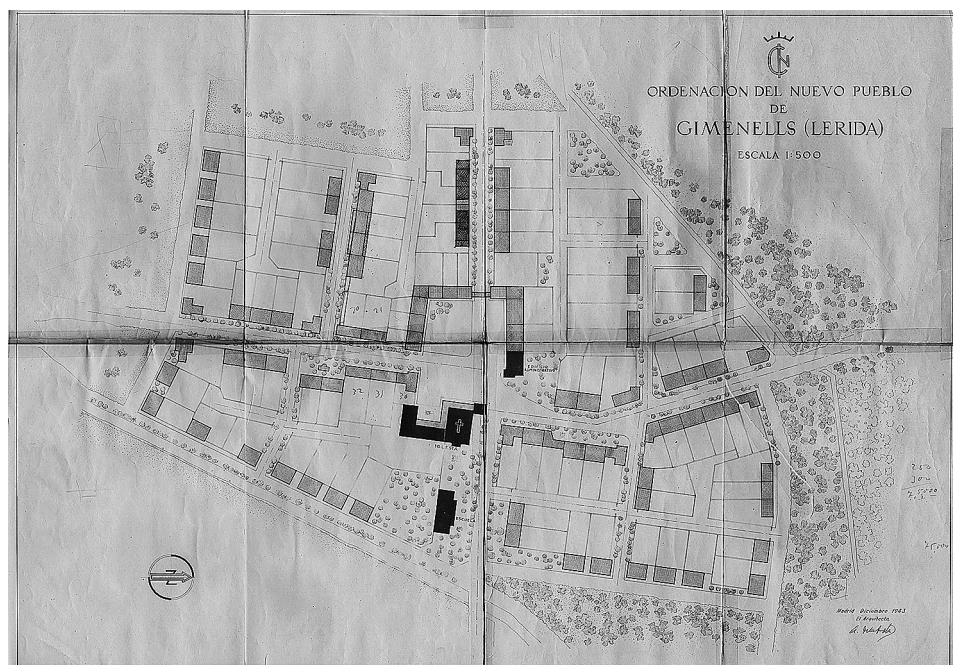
Planta de ordenación del pueblo de Gimennells, por el arquitecto Alejandro de la Sota, diciembre de 1943 (fuente: AHL, Lérida).
